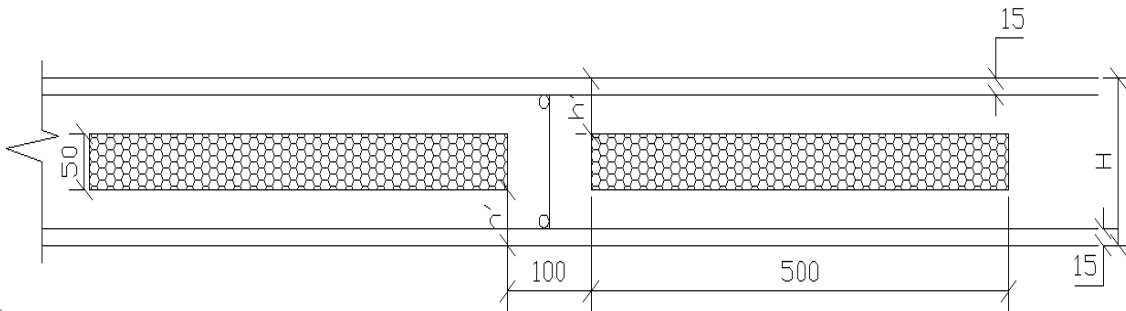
Поперечний переріз перекриття з полістирольними блоками (H – загальна товщина перекриття, h – висота полицки плити)
